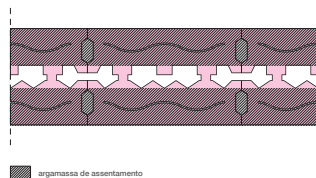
Pormenor do preenchimento com argamassa de assentamento das juntas horizontais numa parede acústica Isolónico® 25
